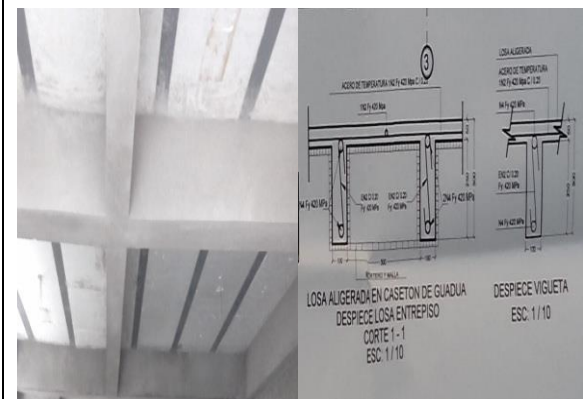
Modificación en el sistema de losa de entrepiso, fuente propia
